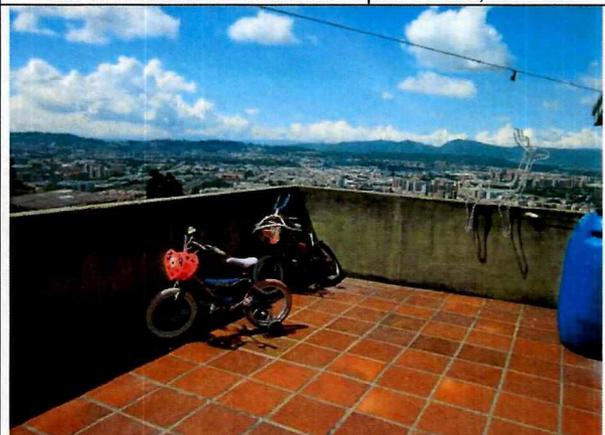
Antepecho de la azotea en tercer nivel, buen estado.
